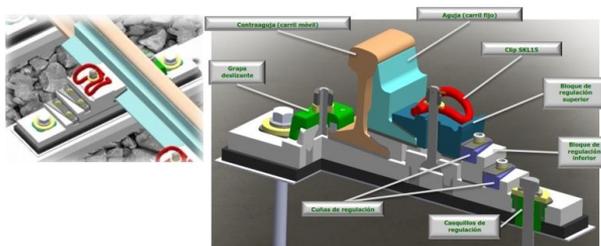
Detalle de placa de deslizamiento para aparato de dilatación, (FUENTE: ADIF crossing switches and expansion devices for high speed track [22])
